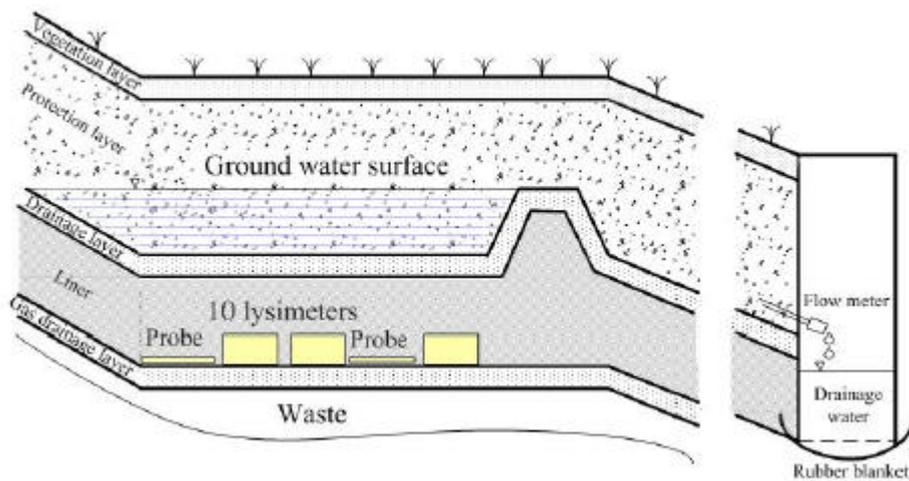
Tveta Landfill: sezione del cap0ping
